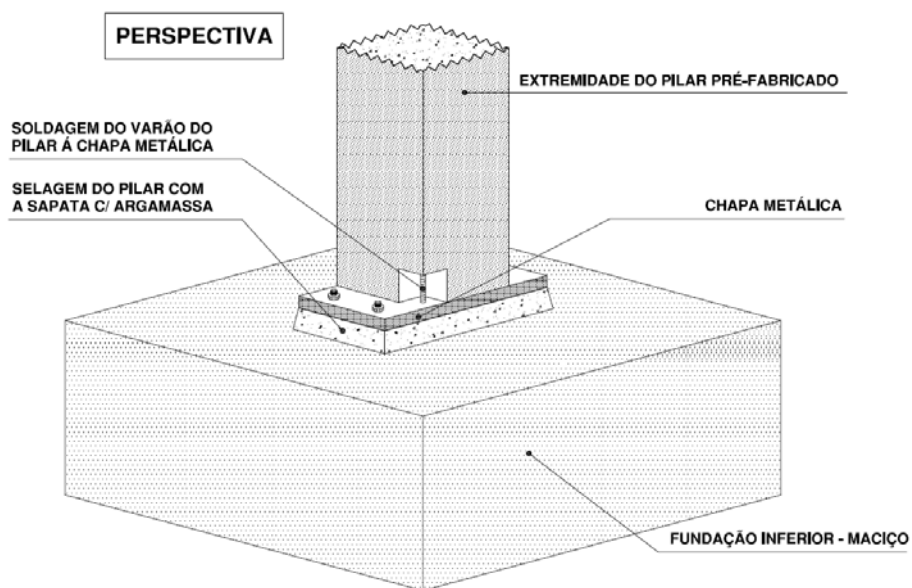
Ligação pilar-fundação com ferrolhos aparafusados (adaptado de [1])
